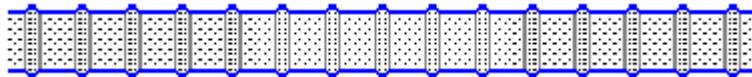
Varillas corrugada utilizada en armadura longitudinal.
